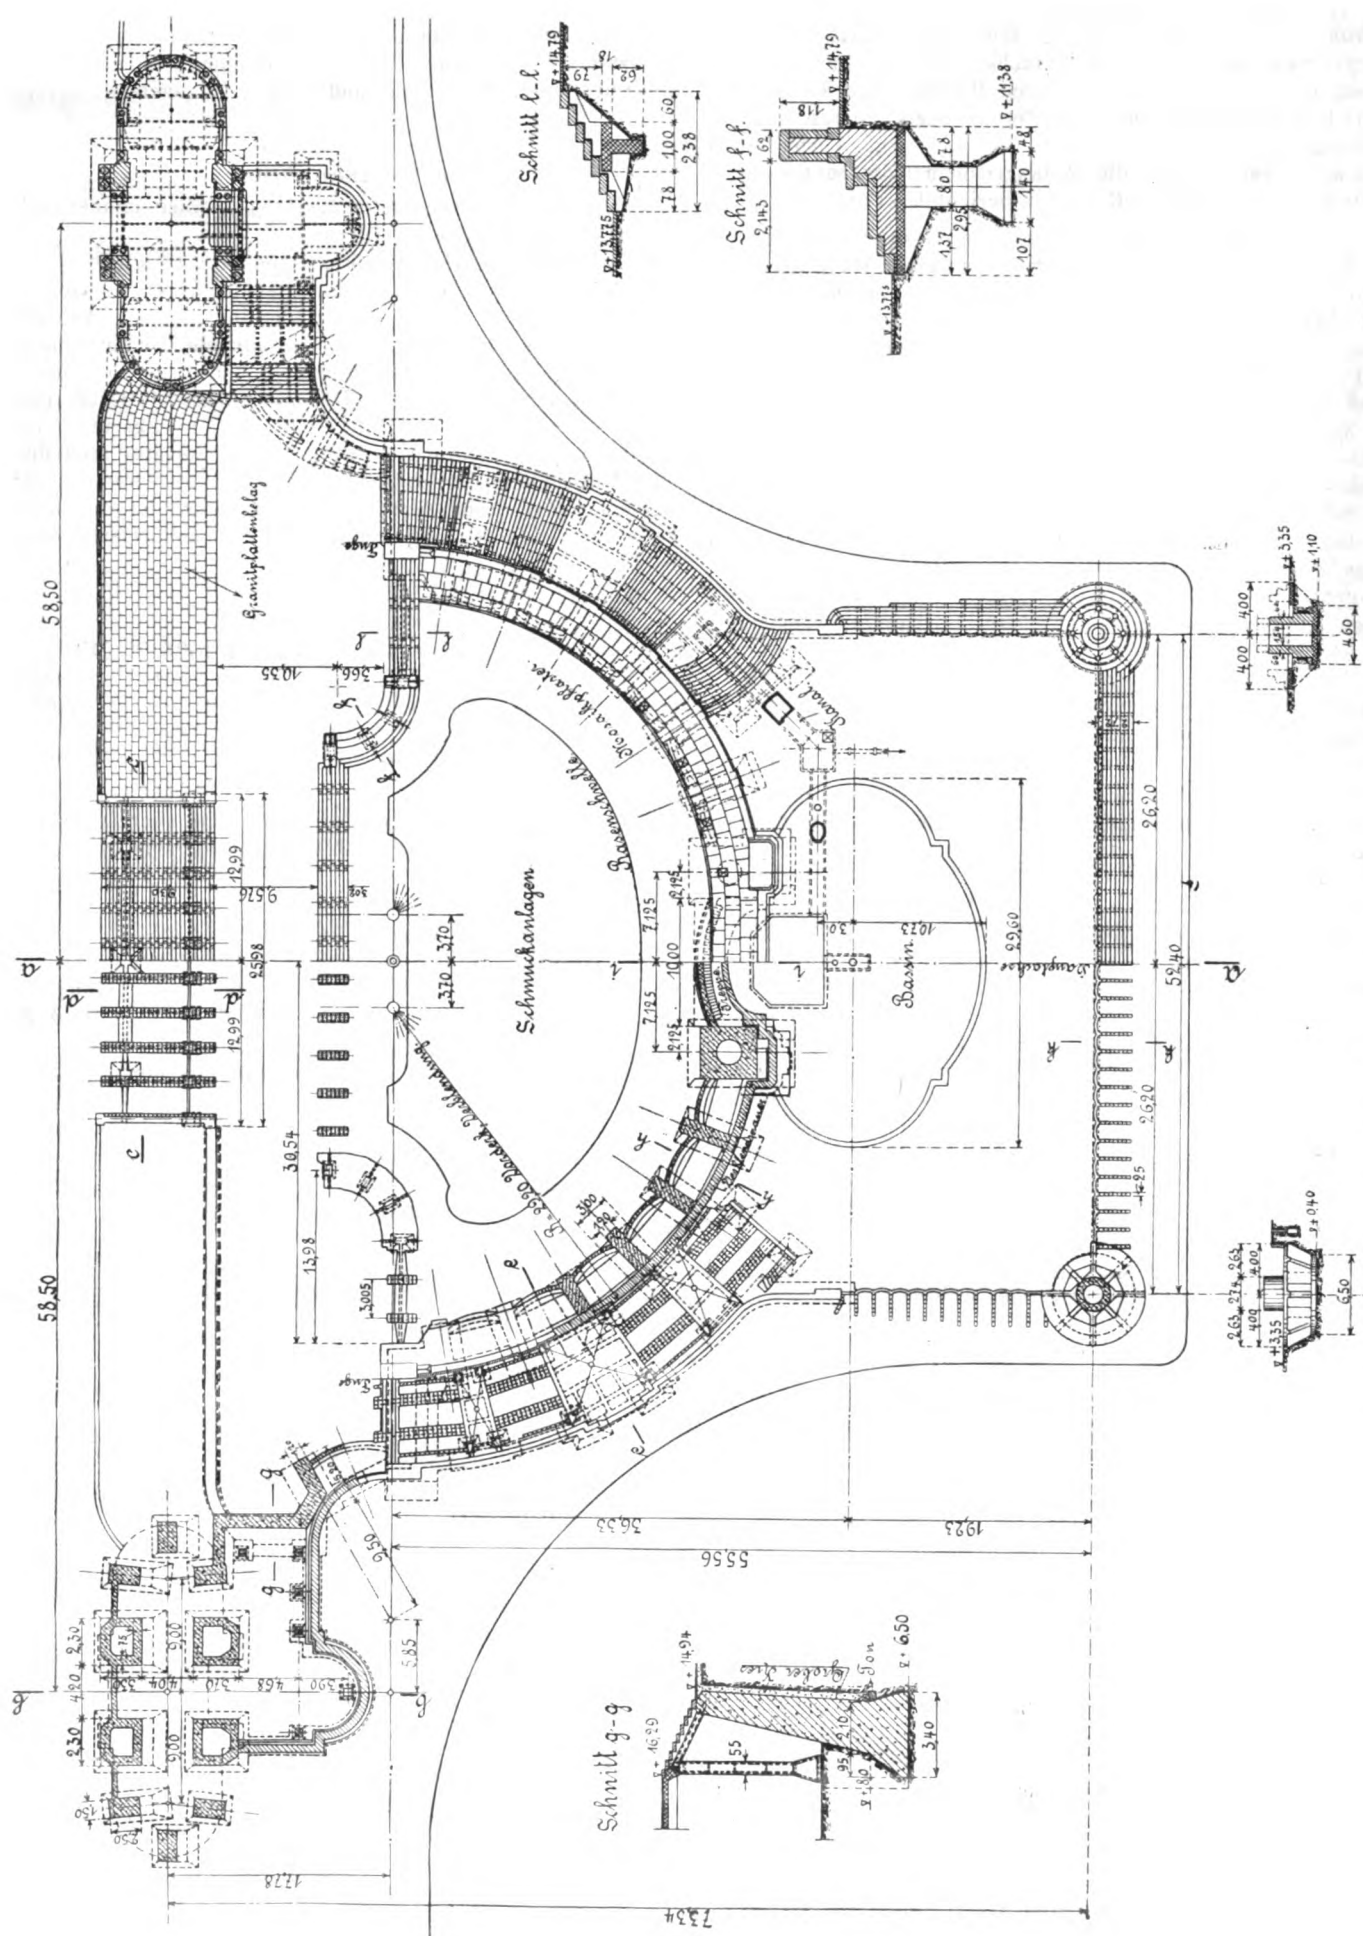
Gesamtgrundriß des Mittelteiles mit Treppenanlagen und Abschlußhallen.
